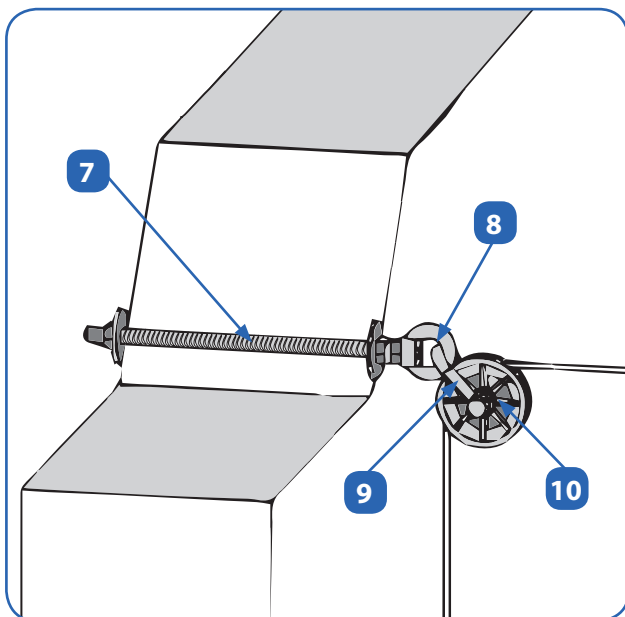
Detalle Torno EXTREMO Automático a pared.
